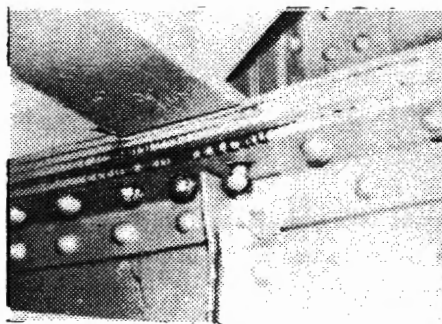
Afrouxamento do rebite na ligação longitudinal-transversal de uma ponte ferroviária.
